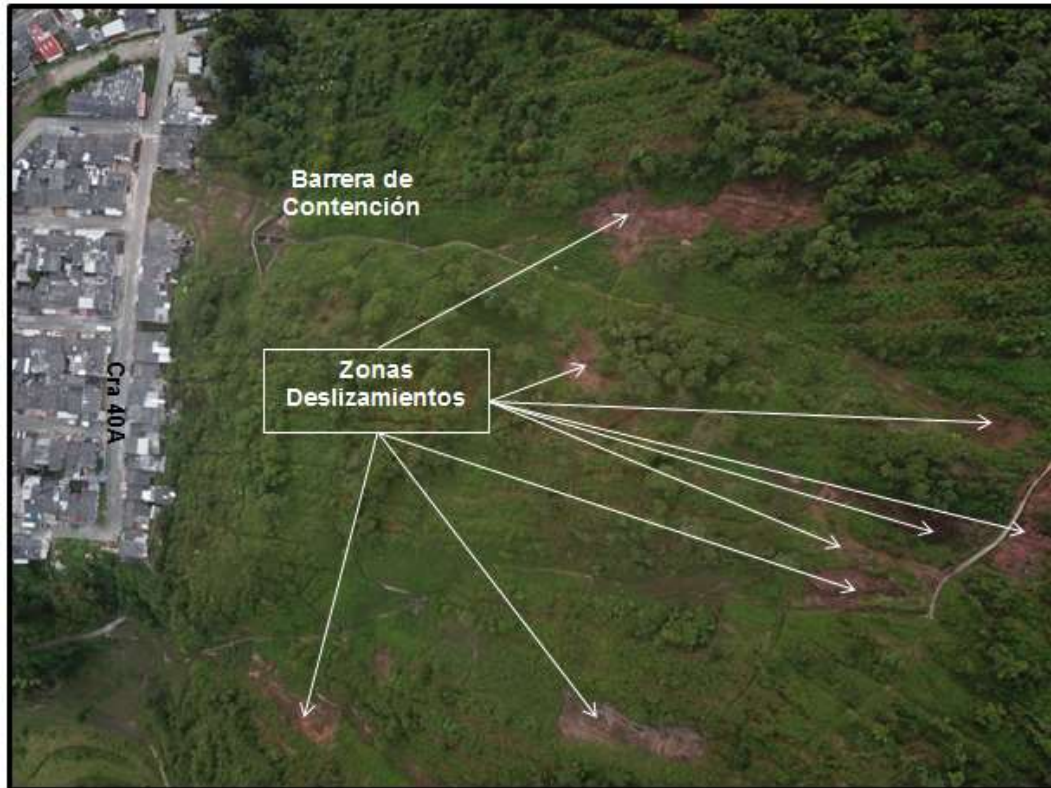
Fotografía aérea sector Aranjuez – Barrera de contención – Casas carrera 40 – Zonas deslizamientos talud superior – Levantamiento Fotogramétrico
